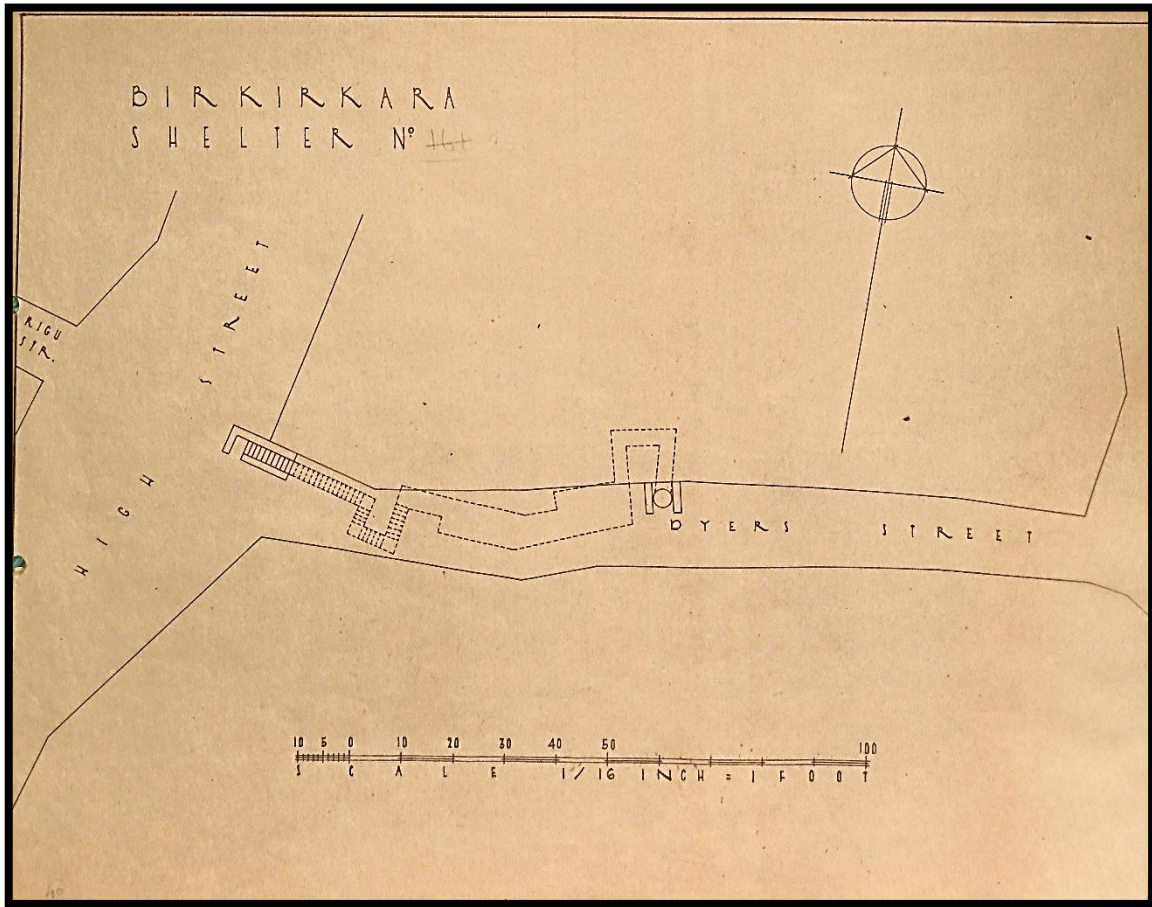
Planta do Abrigo nº16 (25) "High Street – Dyers Street."
